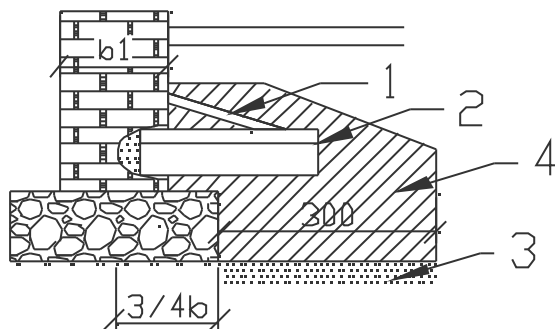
Одностороннее уширение фундамента монолитным банкетом (приливом)
